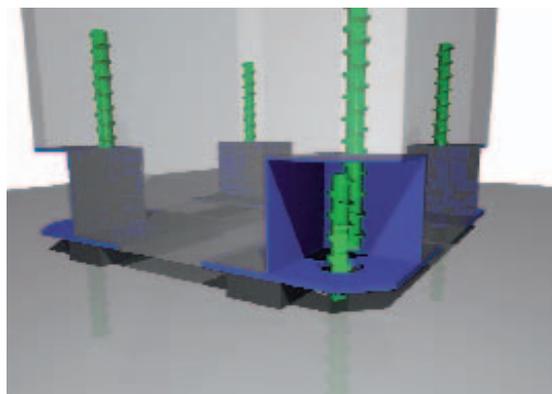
Жесткое крепление ЖБ-колонны (или балки) при помощи коротких высокоэффективных комбинированных стержней арматуры, соединенных внапуск.
